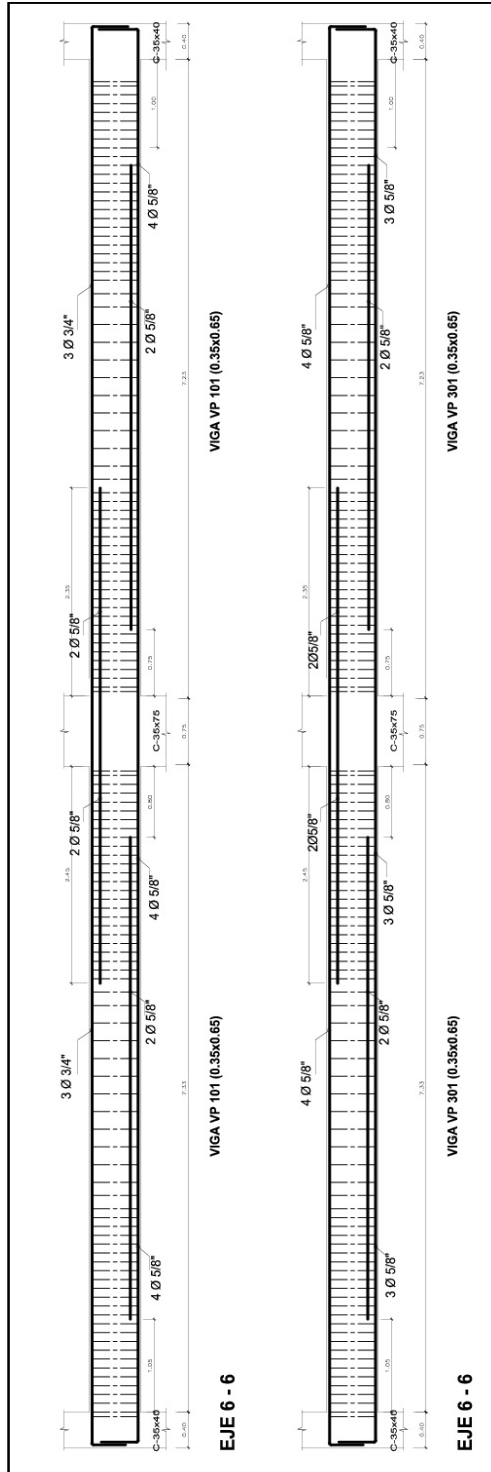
Acero longitudinal en vigas del eje 6-6 del primer y tercer nivel.
